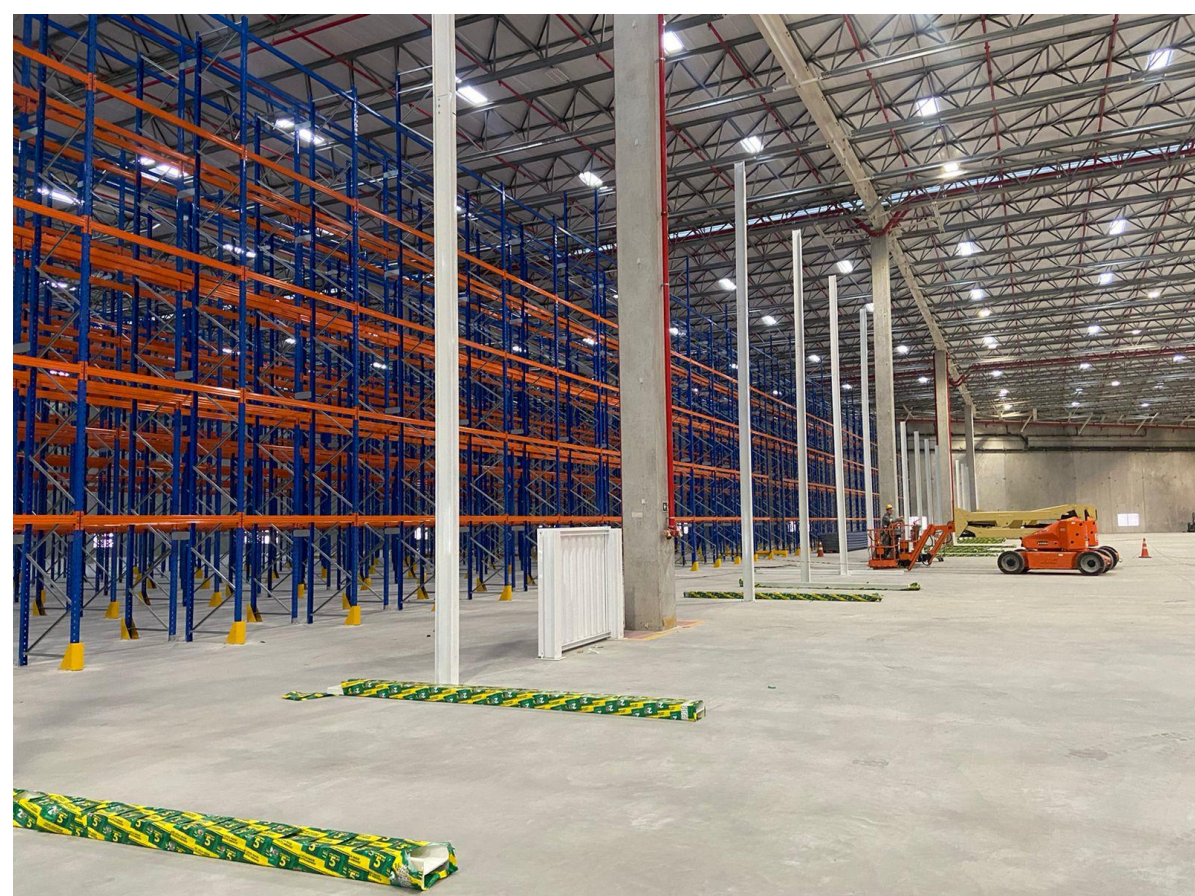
instalação dos pilares da divisória metálica entre os módulos
